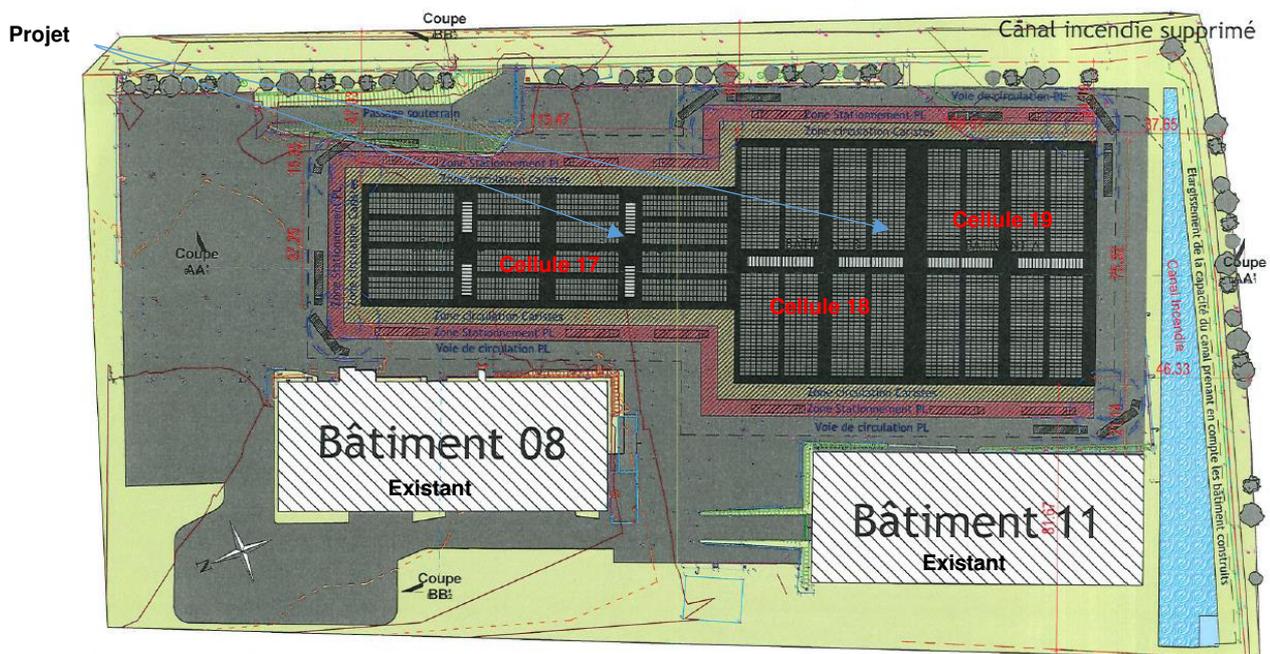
PLAN DU BATIMENT PROJETE (ECHELLE : 1/1000EME).
